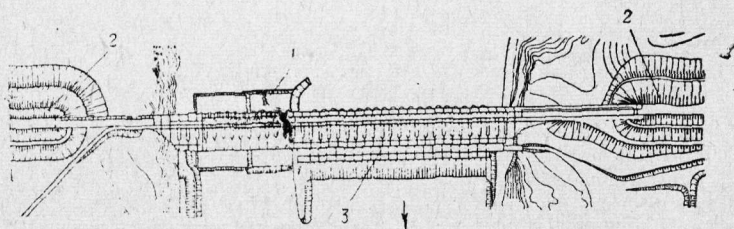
План Братской ГЭС: 1—бетонная плотина; 2—земляные плотины; 3—здание ГЭС
